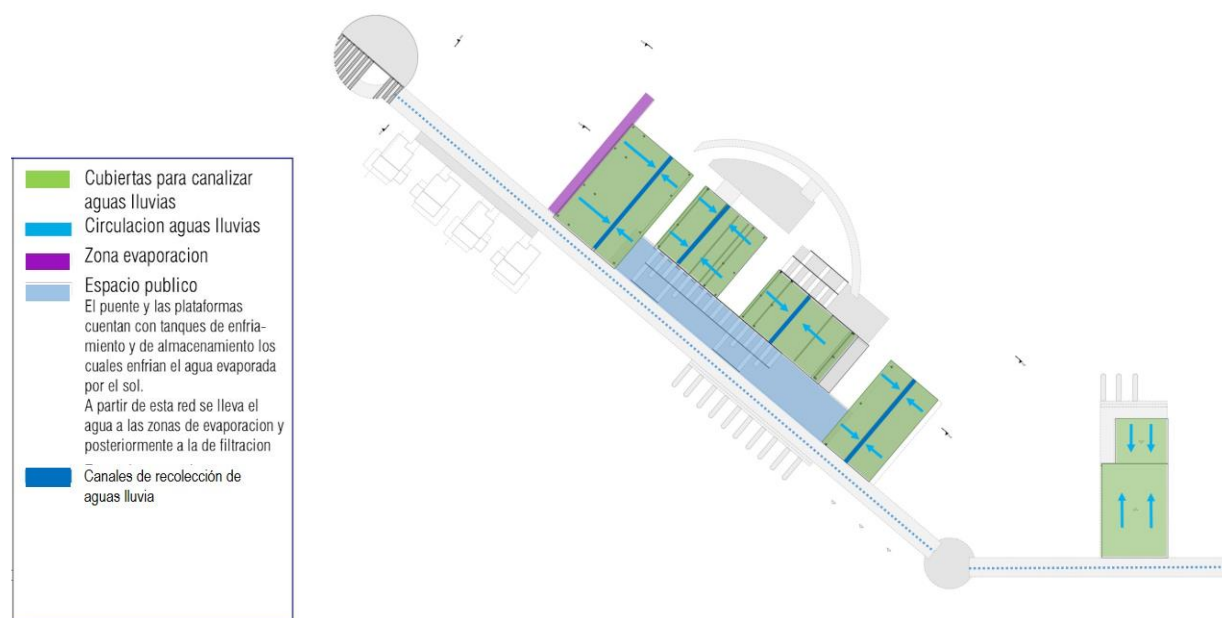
Plano general sistema de cubiertas. Fuente propia.
